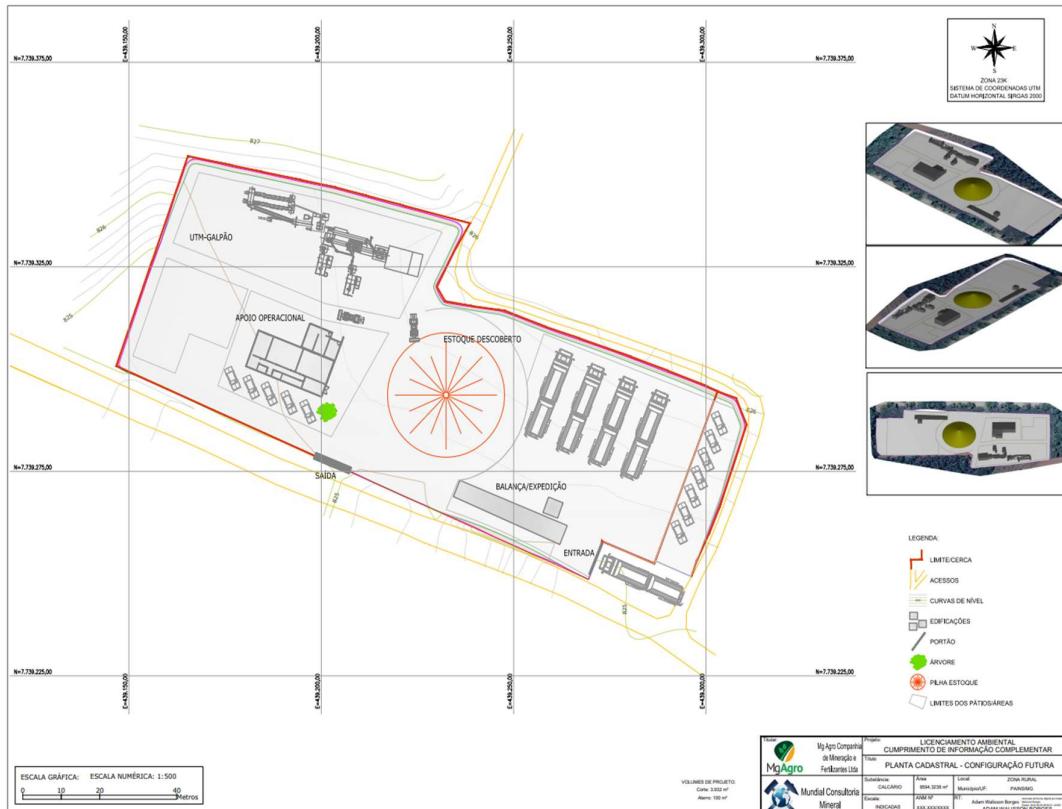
Planta de Detalhe. Fonte: Autos do processo SLA nº 15840/2025.
